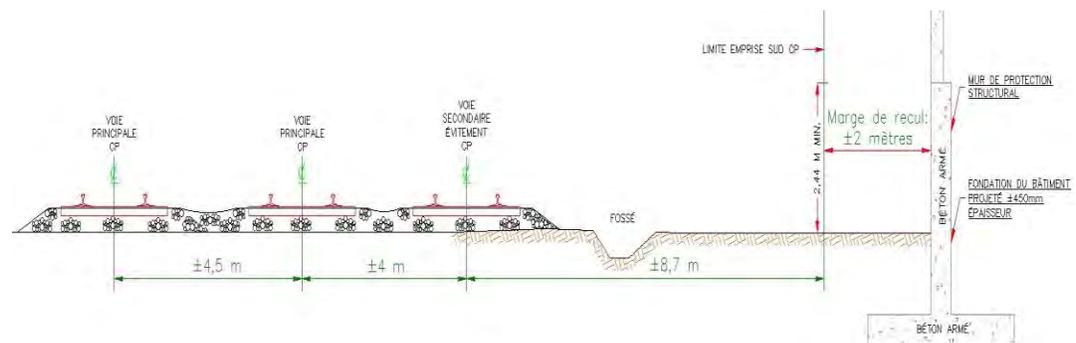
Coupe type du mur de protection structural proposé en béton armé.
